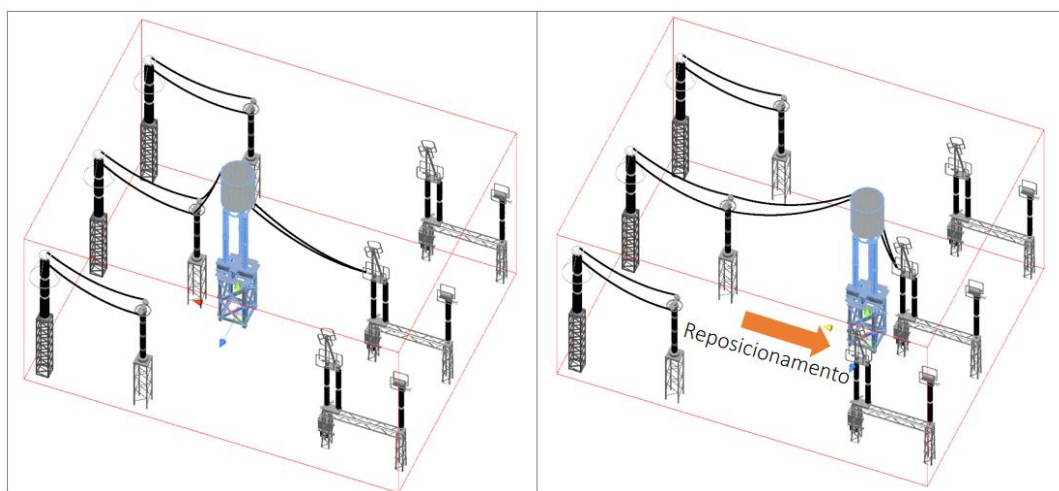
Dinamismo de cabos condutores a medida que um componente é reposicionado
